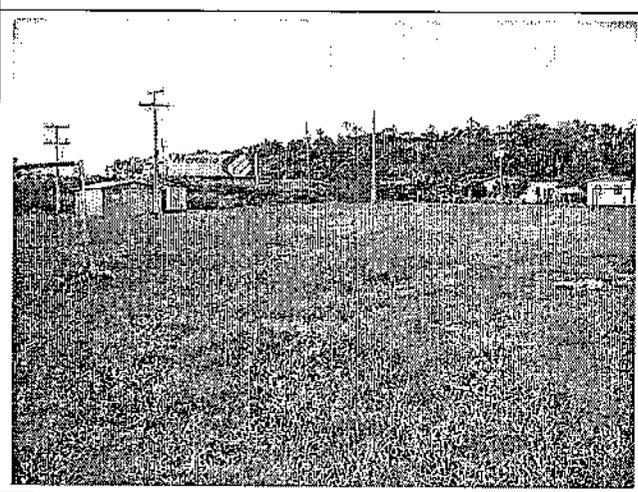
Área a ser instalado o canteiro de obras da Construcap, no lote 04 – RS, ao lado do rio Manpituba já em SC.
